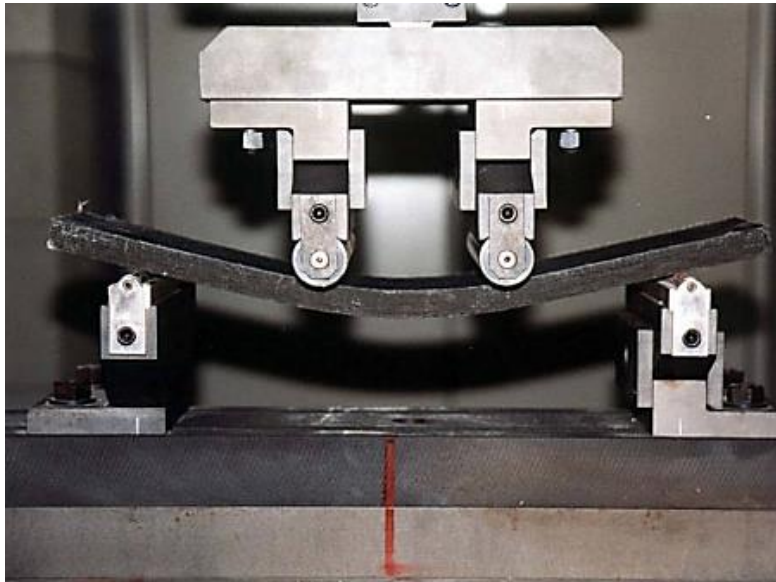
Concreto flexible ultrarresistente sometido a ensayo de carga por flexión. (PRAGMACERO, 2014)
